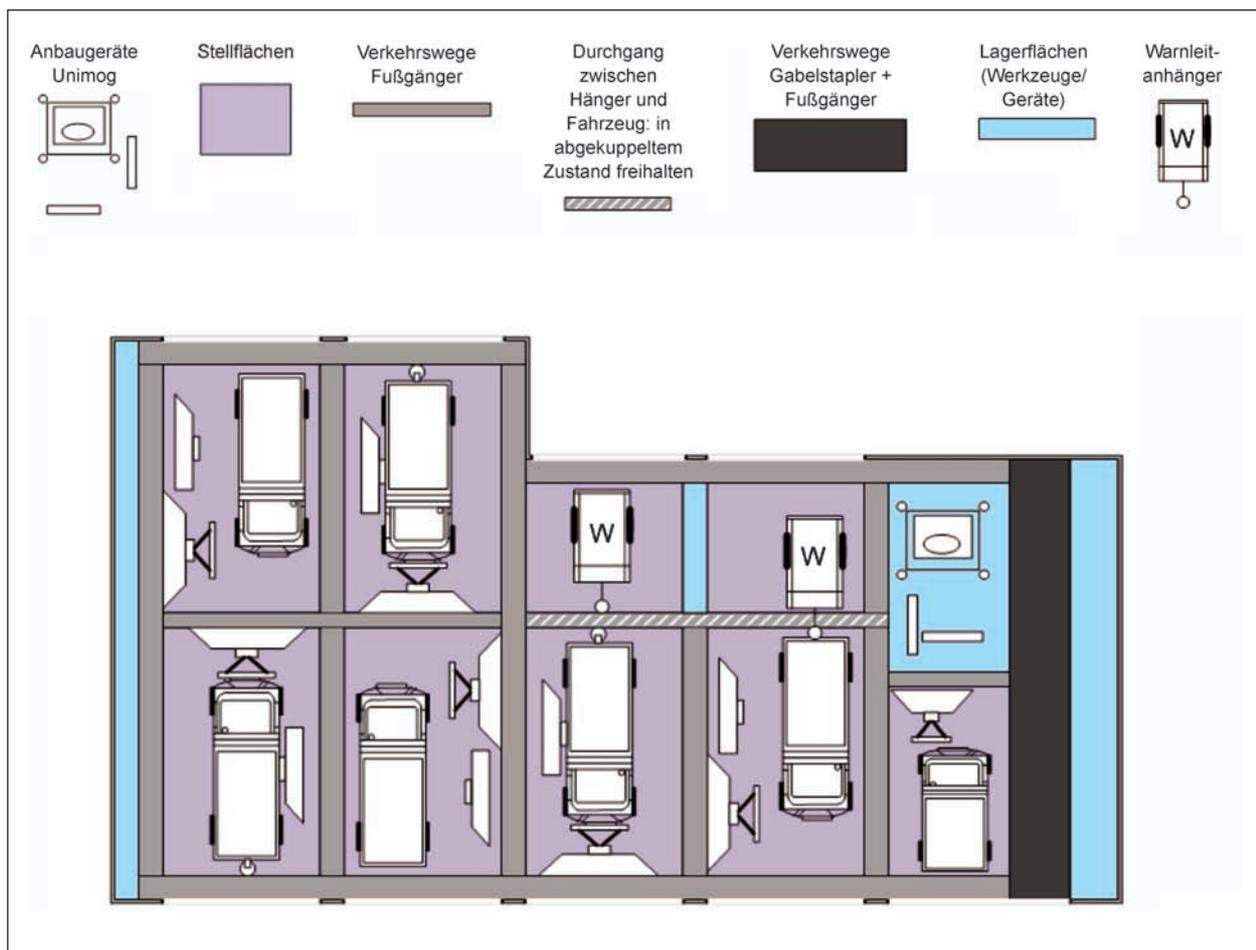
Halle für Großfahrzeuge und Geräte einer AM – Funktionszeichnung 2
